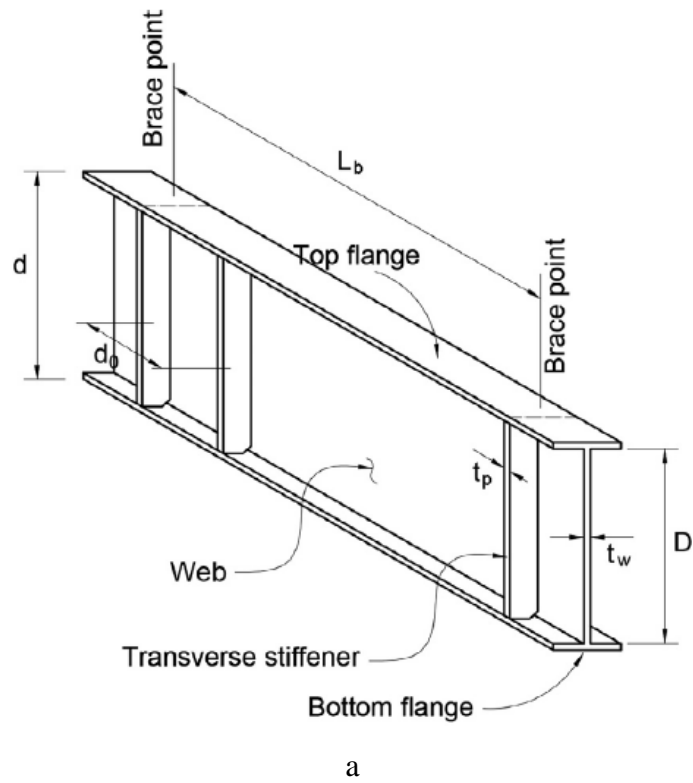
Puentes tipo trabe: a) viga armada, b) ubicación en el puente. [27].
